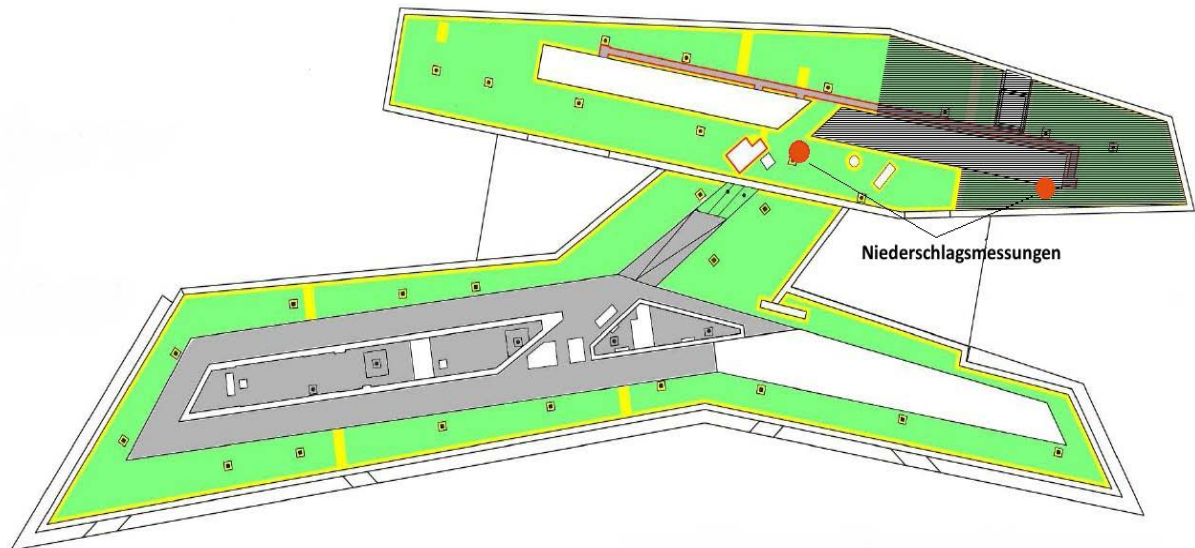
Dachaufsicht HCU-Gebäude mit Standort der Niederschlagsmesssensoren (roter Punkte) und Fläche zur Dachabflussmessung (schattiert) (Quelle: fairplants-system GmbH, T. Brinkmann, bearbeitet).
